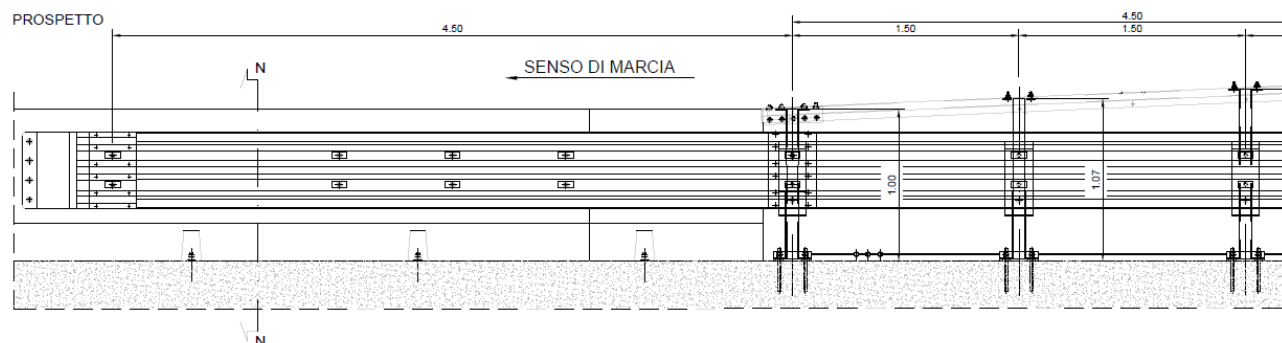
Collegamento tra barriera metallica e profilo redirettivo in c.a.
